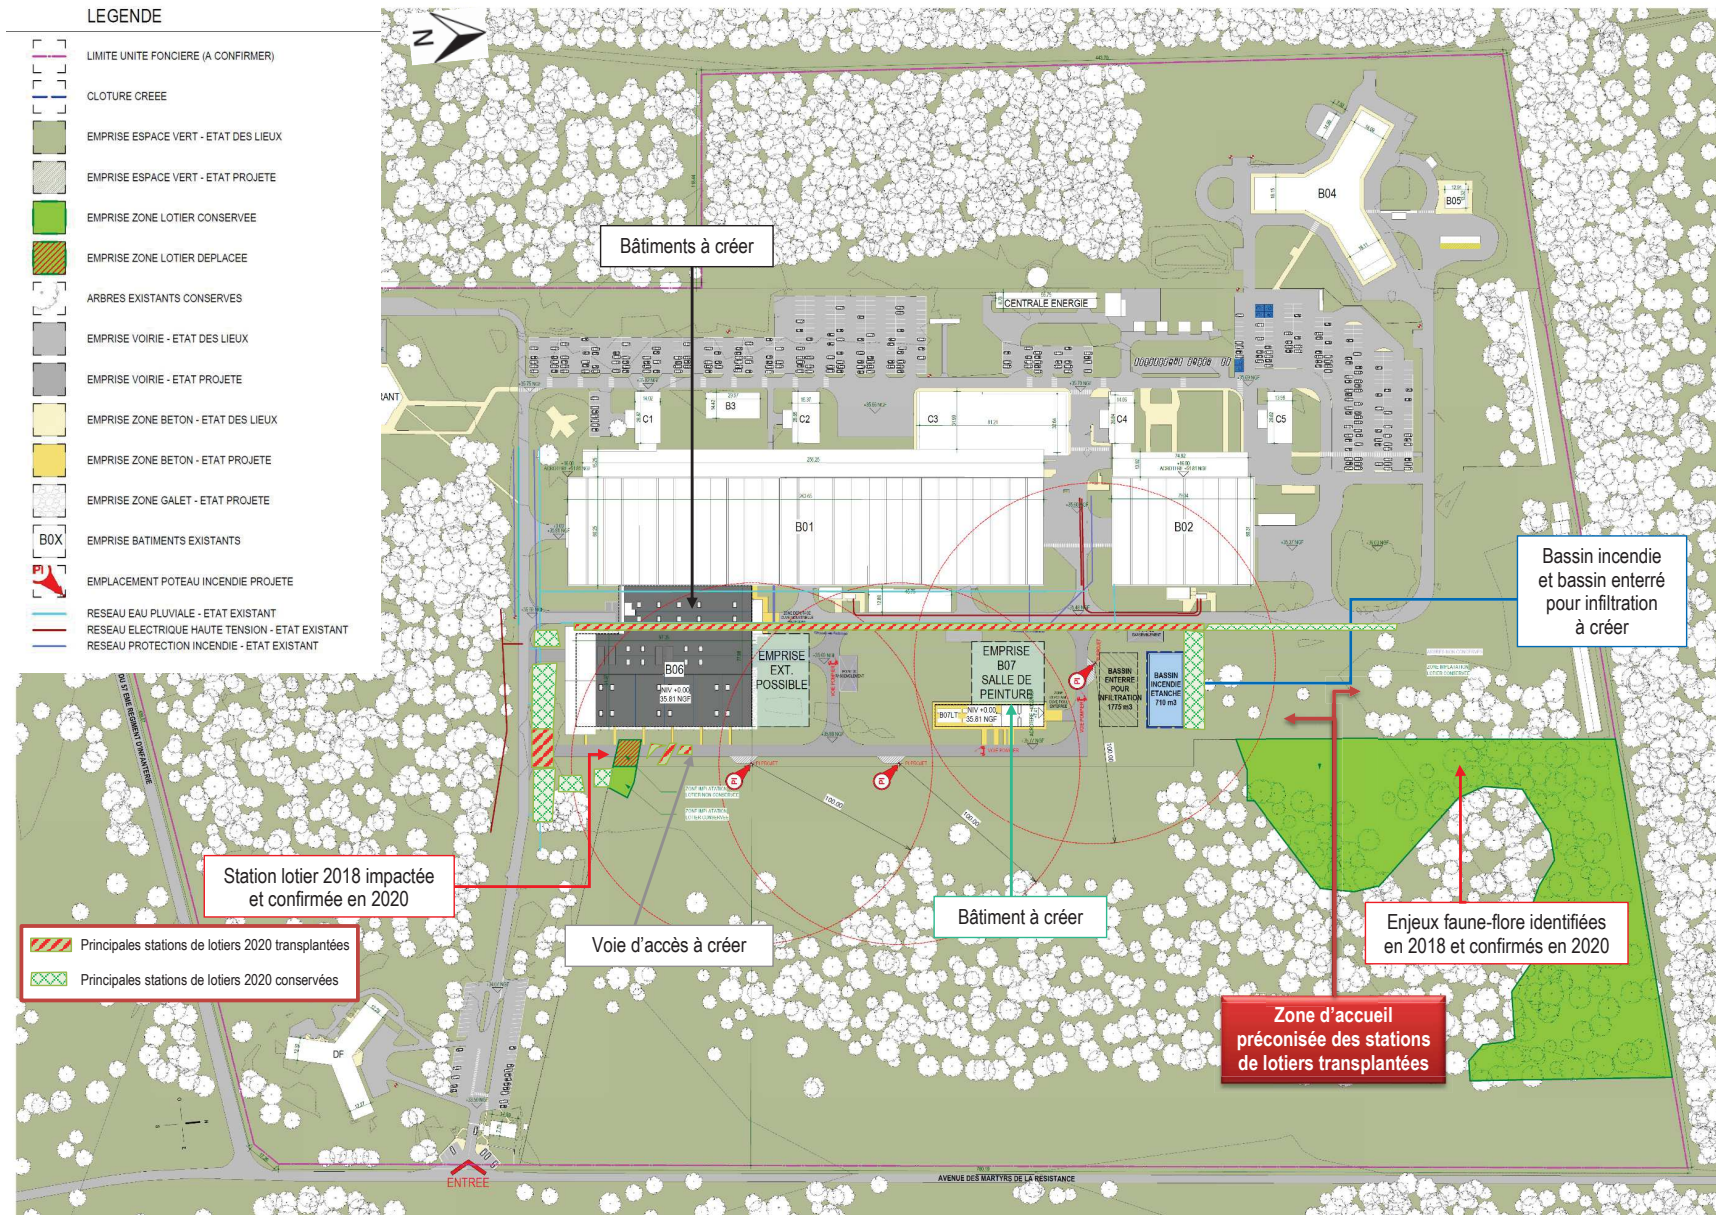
Plan de masse du projet (plan de Dassault Aviation).
